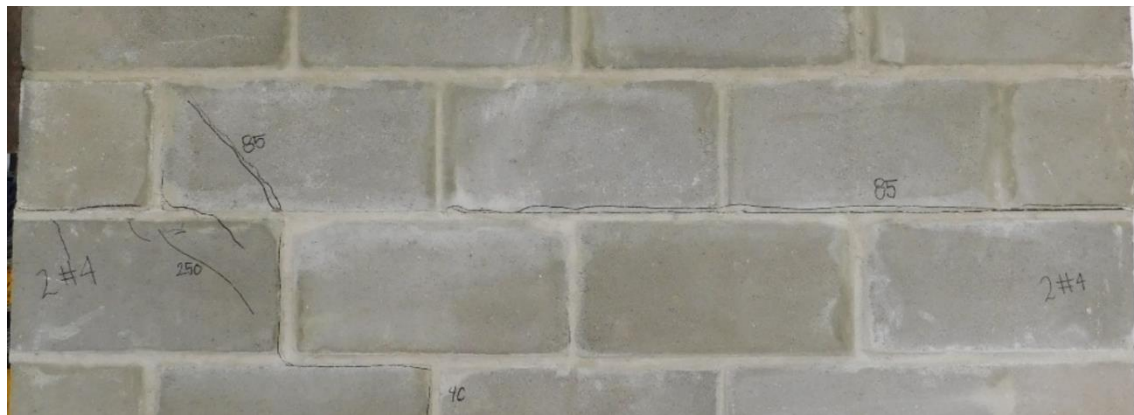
Fisuras en la cara frontal del muro MC-2#4/60
